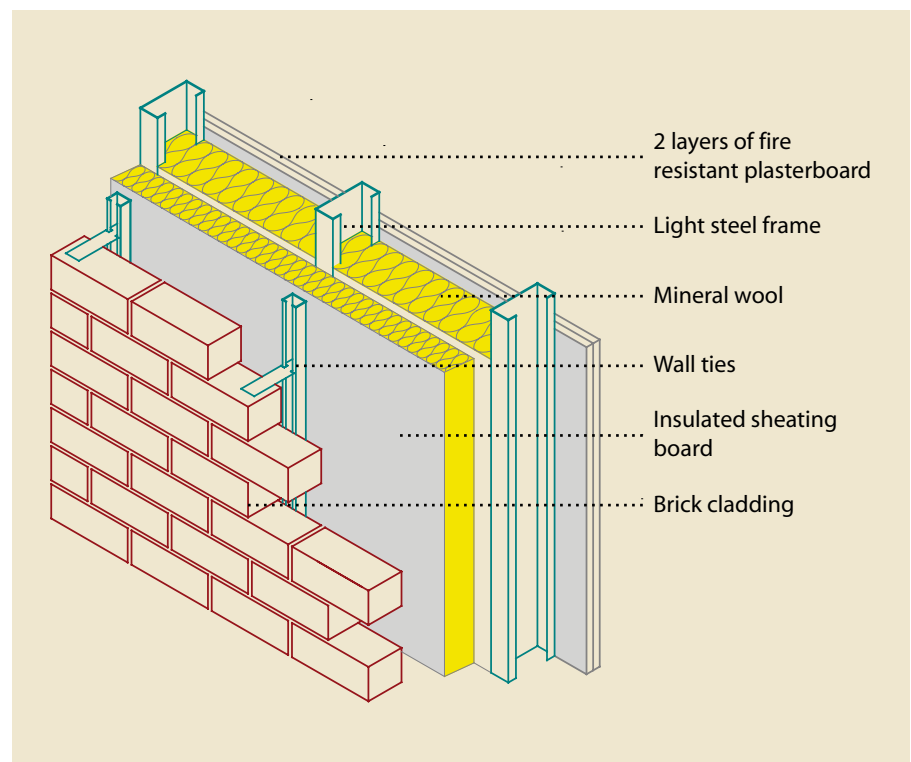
Panel de fachada exterior con cerramiento de ladrillo
